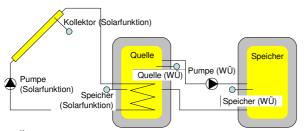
Schema (0.2) 1F1S2W, Anschlussplan
